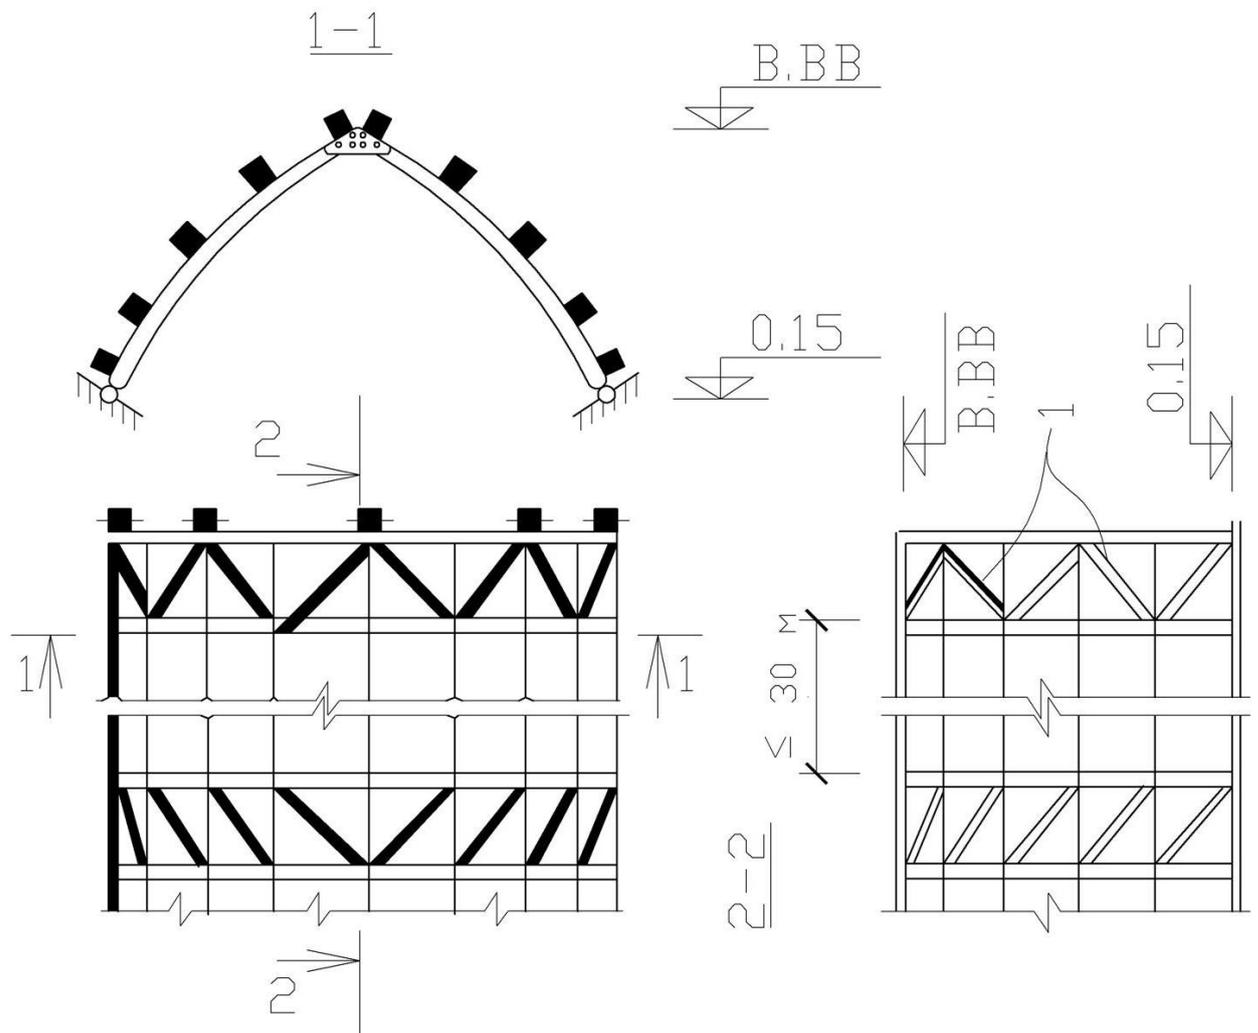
Схема каркаса здания на основе трехарочной арки: 1 – горизонтальные связи в покрытии.
